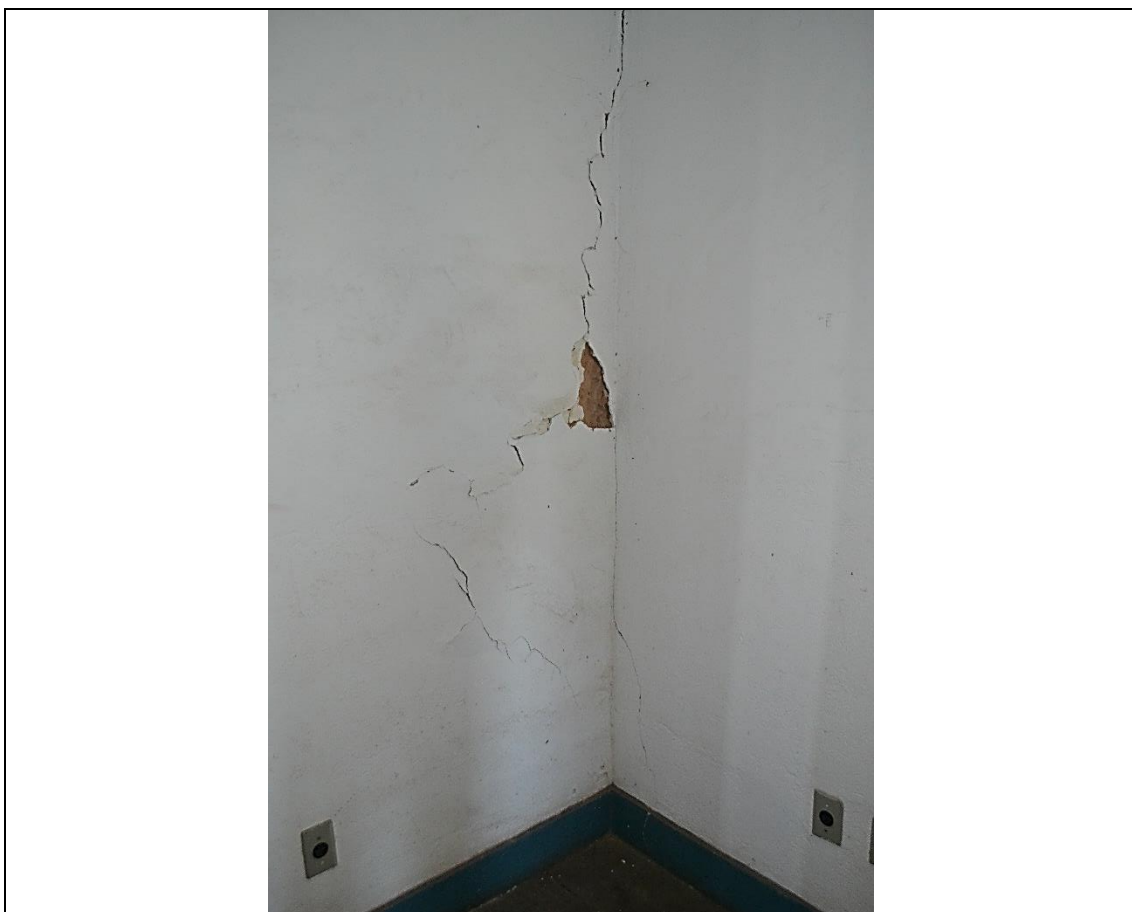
Parede de pau a pique, existente na sala 26 do pavimento superior, com trincas. Fonte: Ney Nolasco.
